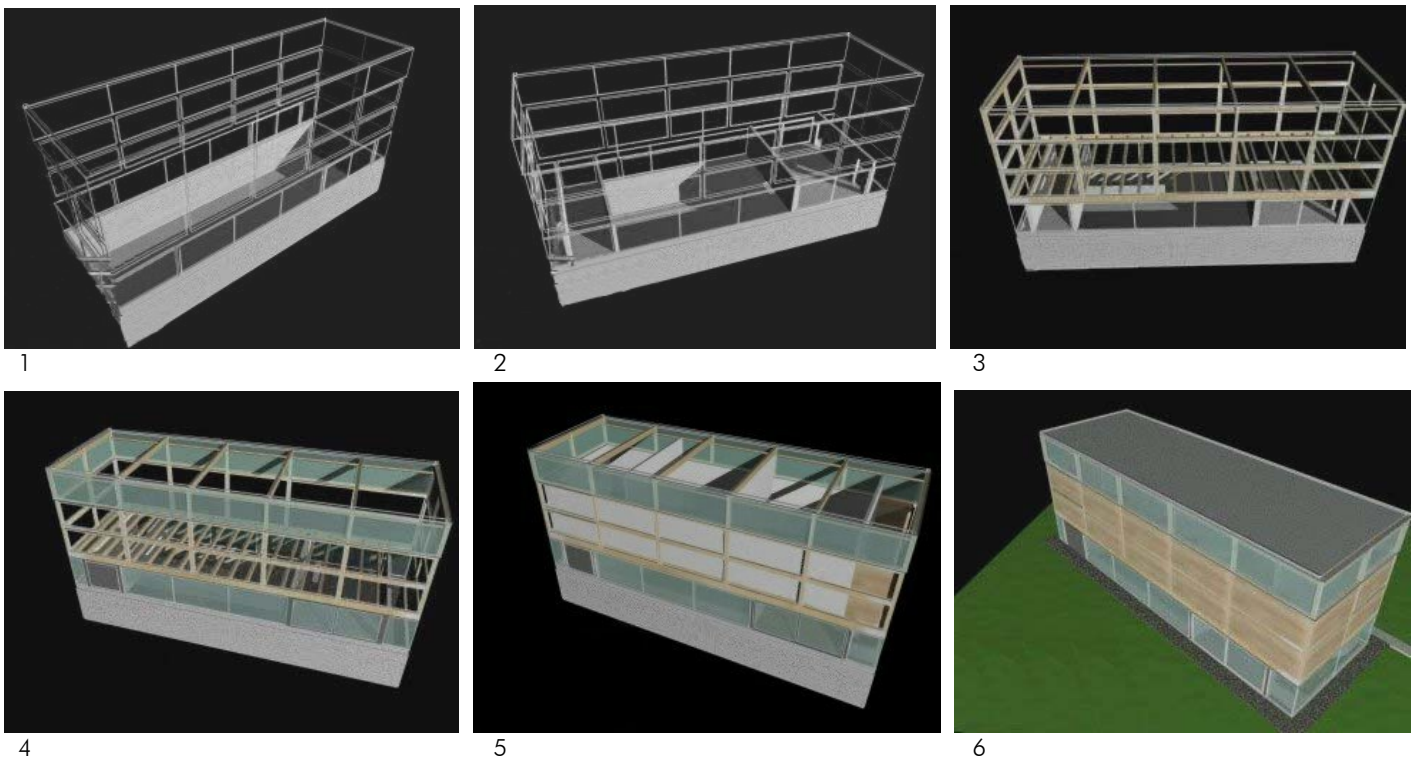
Proceso constructivo del edificio: 1. caja de hormigón armado a nivel de subsuelo; 2. sobre ésta se apoyan dos estructuras también de hormigón armado de sección "U" a nivel de planta baja; 3. estructura de entramado pesado de madera de abedul de los pisos superiores, formado la estructura principal de las galerías de exposición; 4. fajas vidriadas; 5. revestimiento del volumen intermedio con paneles de madera multicapa; 6. revestimiento exterior de madera compensada.
